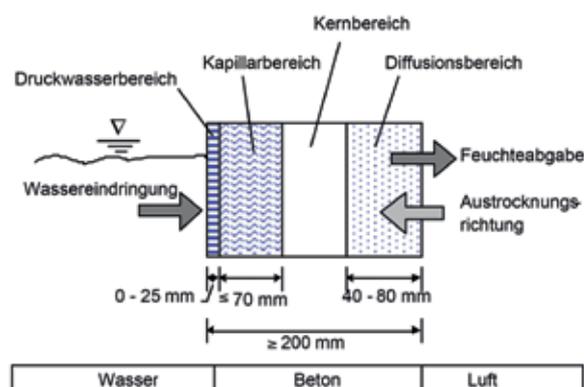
Arbeitsmodell für Feuchtebedingungen in einem Betonbauteil-Querschnitt unter einseitiger Beaufschlagung mit drückendem Wasser, Beton C30/37, $w/z \leq ,55$ [3]
